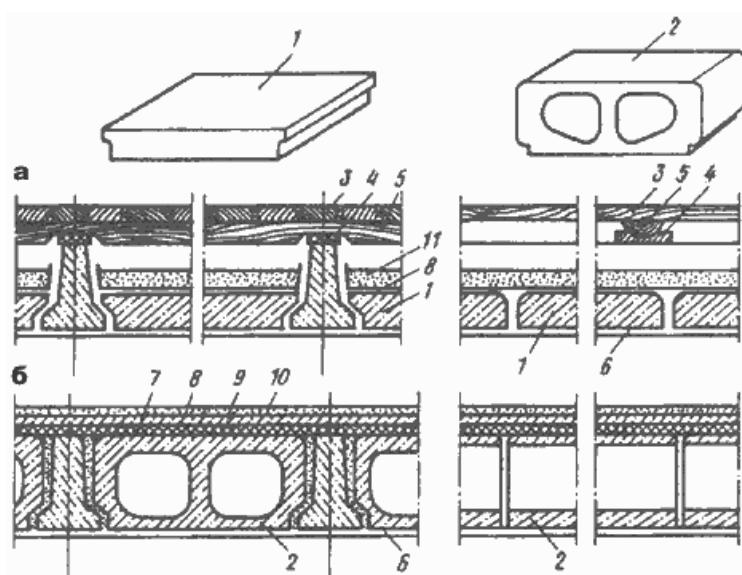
Перекрытия по железобетонным балкам с накатом из сплошных плит (а)
